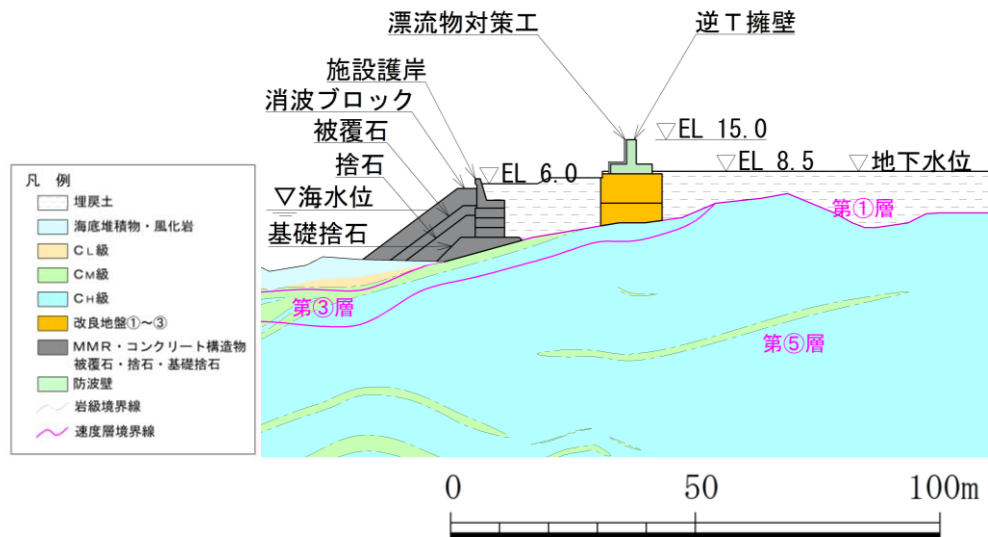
防波壁（逆 T 擁壁）の横断面図（②-②断面）
